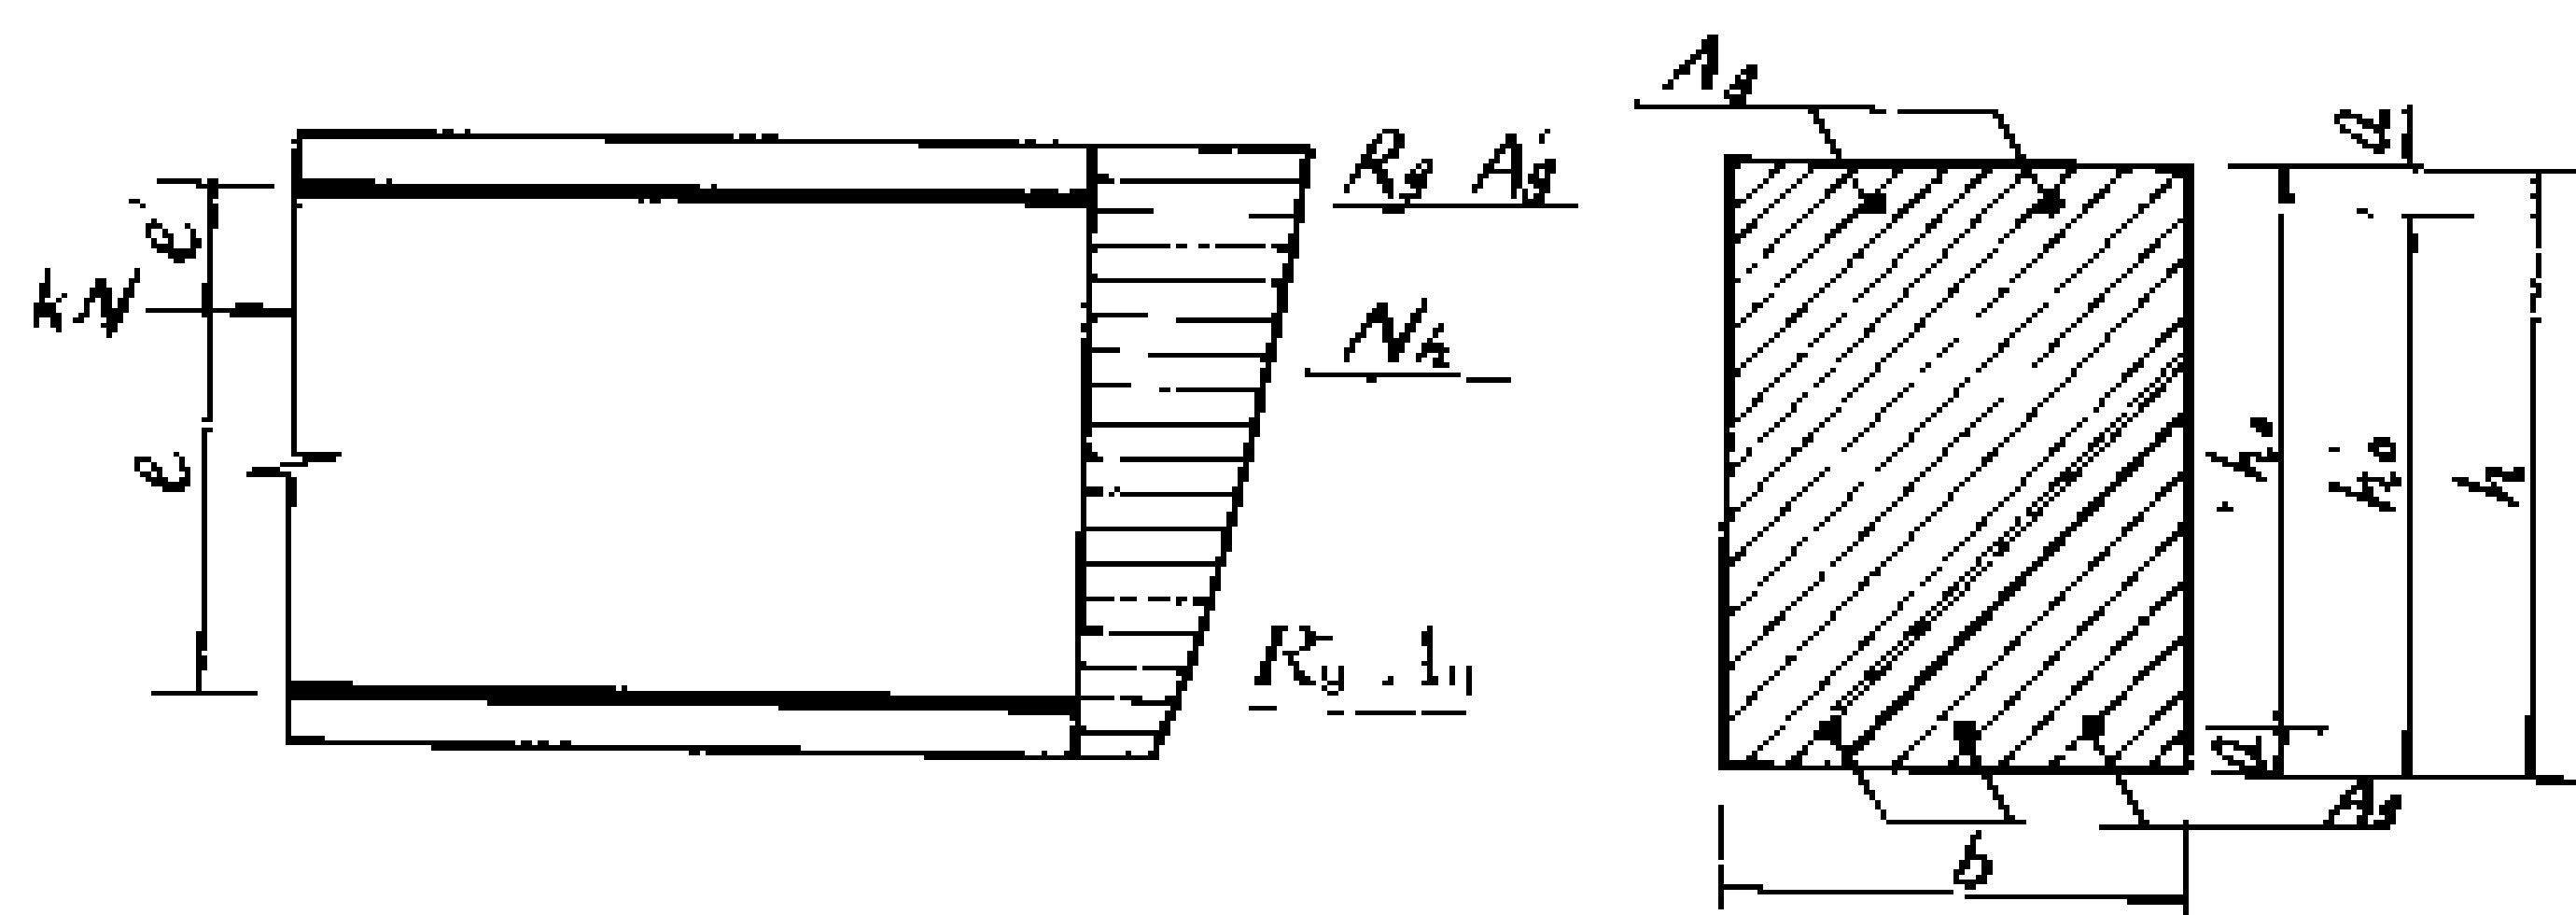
钢筋混凝土小偏心受压构件截面强度计算图
